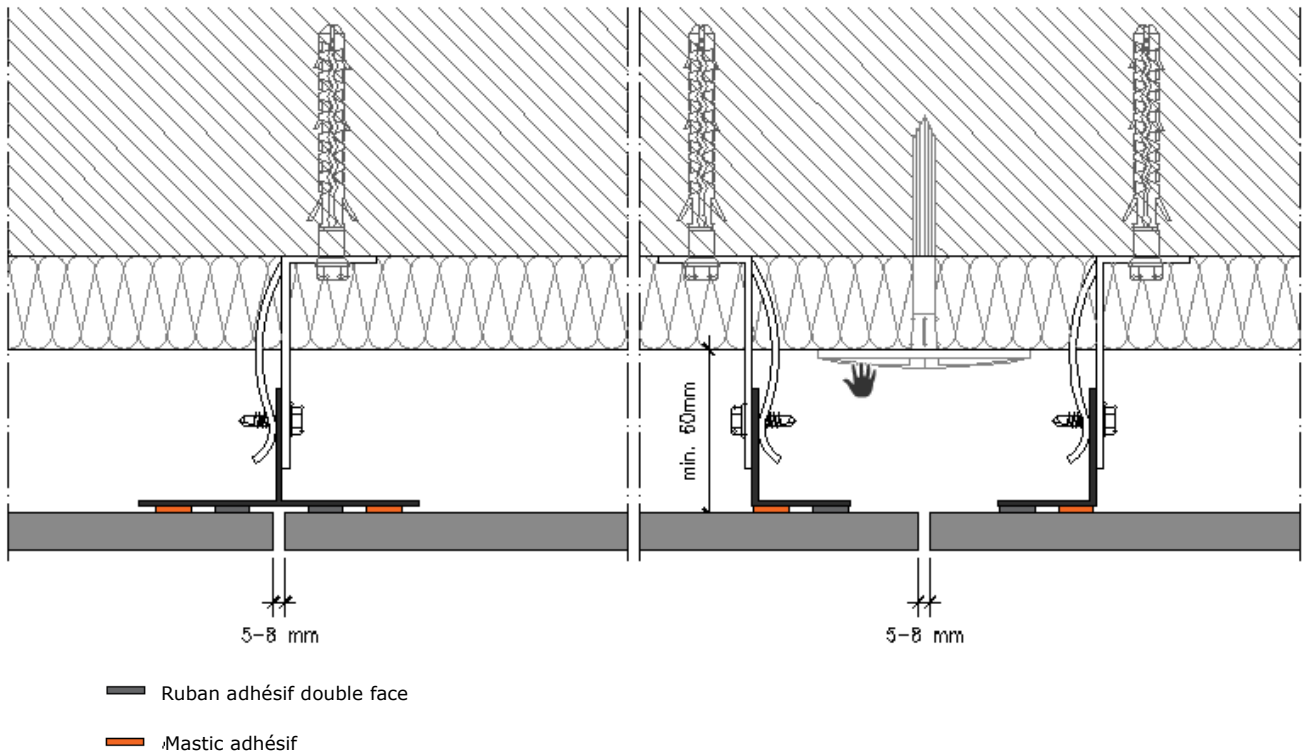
Découpe horizontale, joint entre les panneaux
